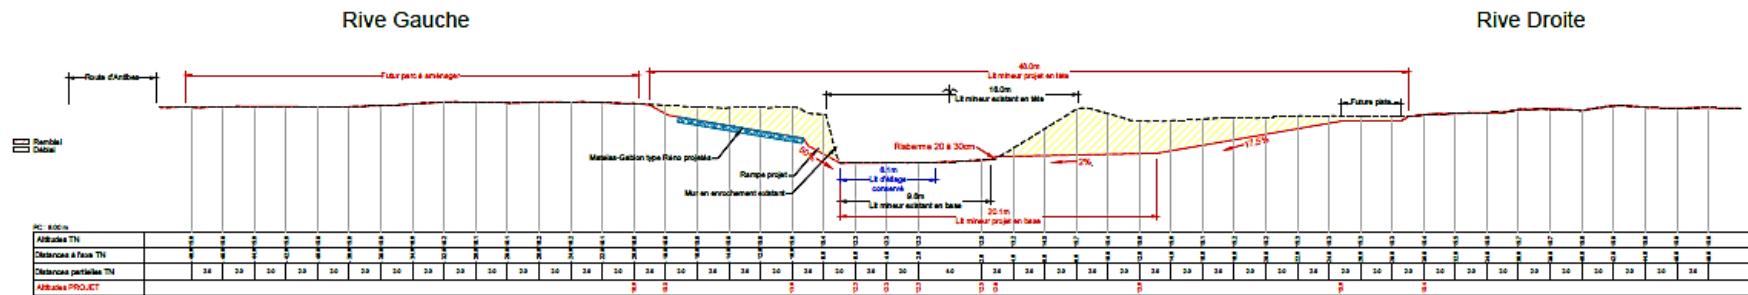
Coupe de profil n° P20. L'emplacement du profil est reporté sur la Figure 2 ci-avant.
